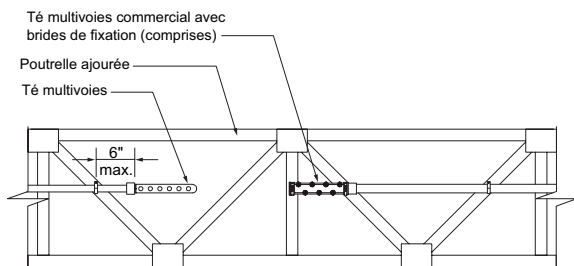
Support de tés multivoies sur des poutrelles de bois ajourées
